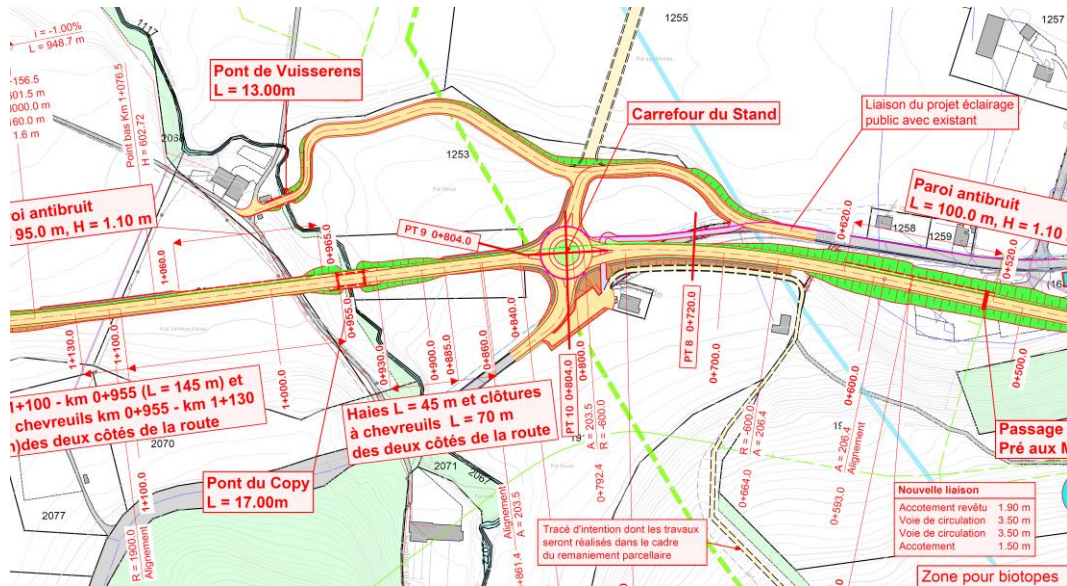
Situation pont de Copy et carrefour du Stand- extrait plan EMMA+ (28.06.2019)
